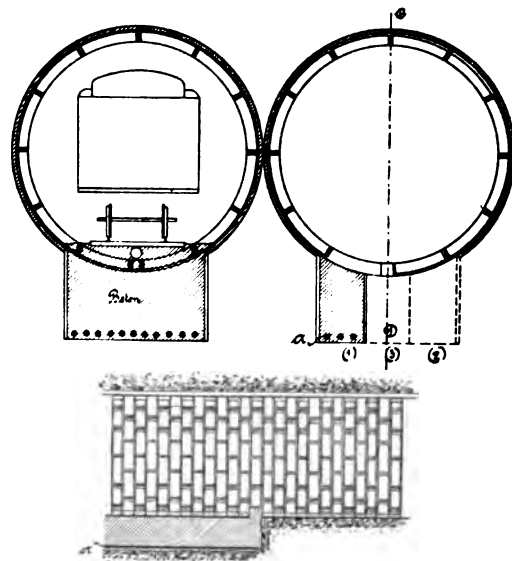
Vorgeschlagene Gründung des North River-Tunnels.
